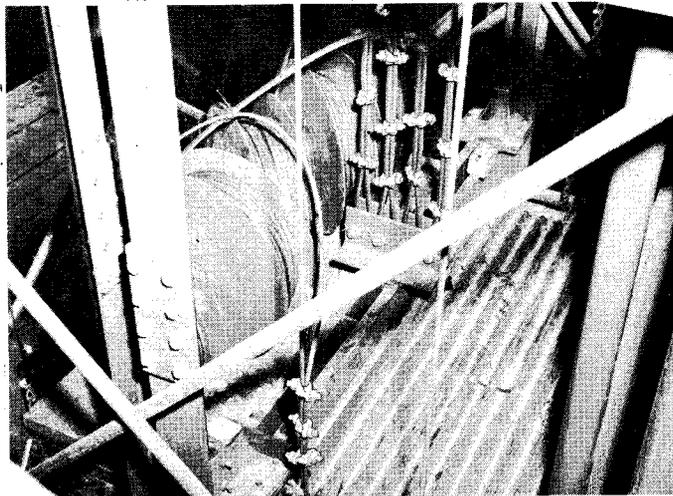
Vista demostrando un carretón de cable almacenado para en caso que haya que reponer cable. Esto evita el empate de cables.
